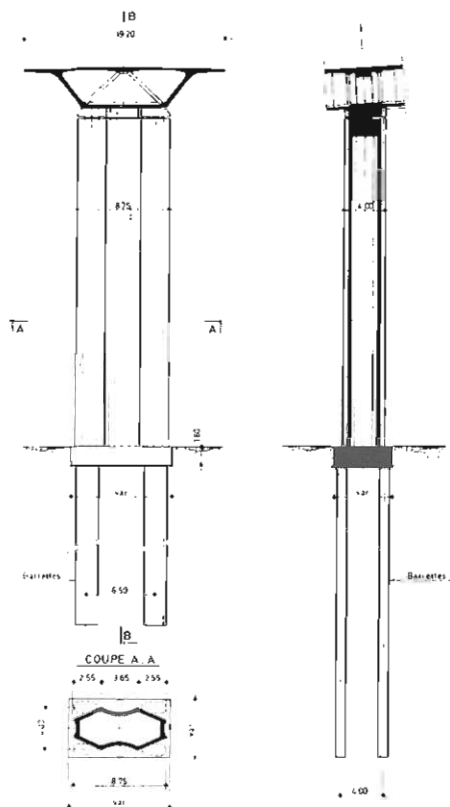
Puente de Brotonne. Detalle de las pilas y tablero.
